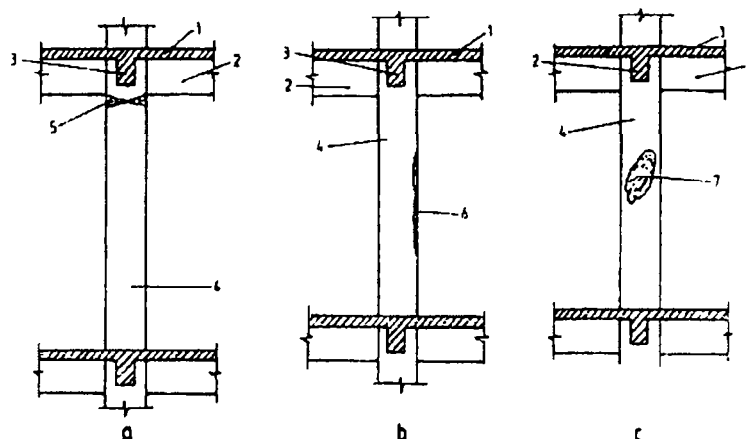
Degradari la stâlpii din beton armat;
